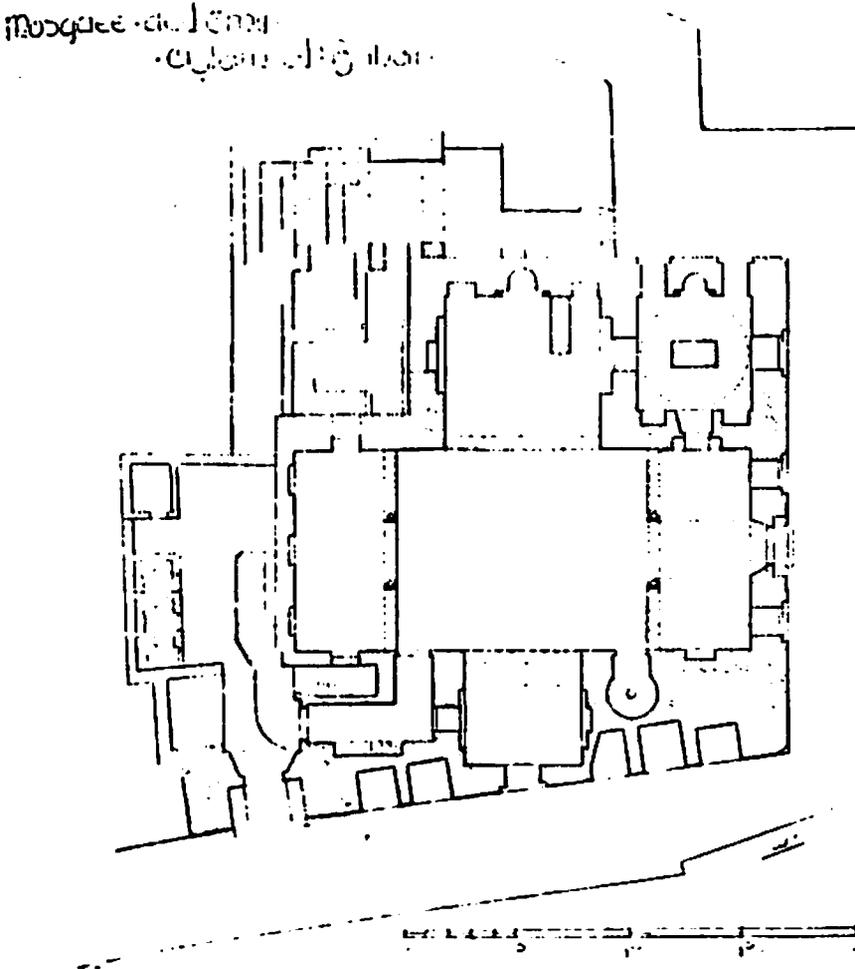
مسقط أفقى لمسجد وقبة الماس الحجاب «عن كلر»
